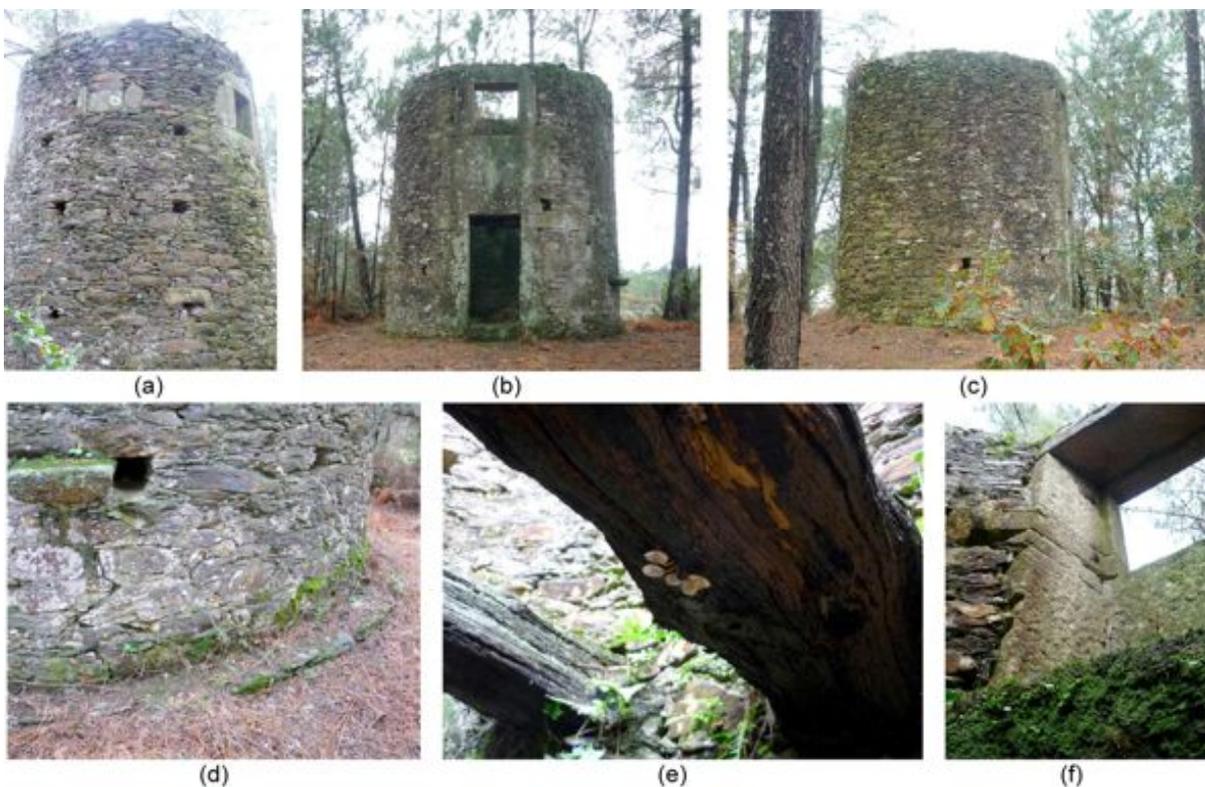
Moinho de vento LN15: (a) Alçado norte; (b) Alçado nascente; (c) Alçado sul; (d) Pormenor visível da fundação em xisto; (e) Avançado estado de podridão e colonização biótica dos *paus rolados* ainda existentes; (f) Pormenor da lavra interior das cantarias de granito
